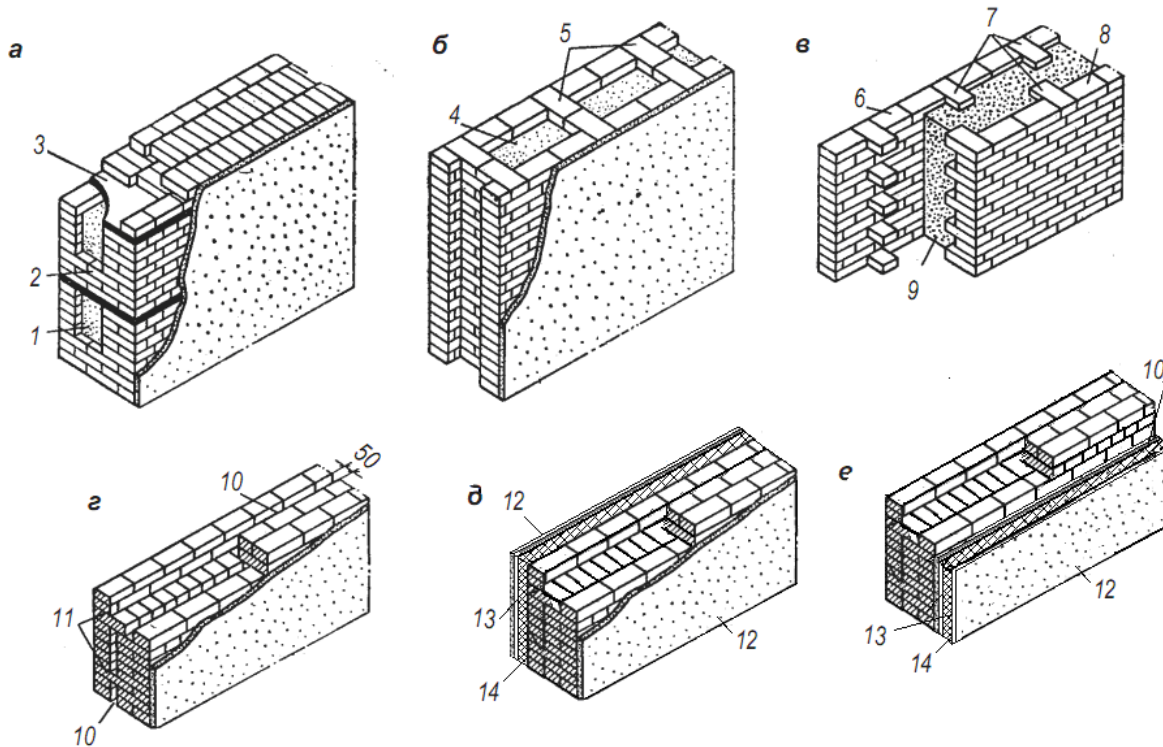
Конструкції полегшених цегляних стін: а – кладка з трьохрядними діафрагмами; б – колодязна кладка; в – анкерна цегляно-бетонна кладка; г – кладка з повітряним прошарком; д – із зовнішнім утепленням; е – те ж, із внутрішнім; 1 – легкий бетон, або другий утеплювач; 2 – діафрагма із трьох рядів кладки; 3 – стяжка із розчину; 4 – колодязь, заповнений утеплювачем; 5 – вертикальна діафрагма із цегли; 6 – зовнішня верста; 7 – анкери із цегли; 8 – внутрішня верста; 9 – легкий бетон; 10 – повітряний прошарок; 11 – перев'язка поперечиками; 12 – штукатурка; 13 – утеплювач плитний; 14 – пароізоляція
